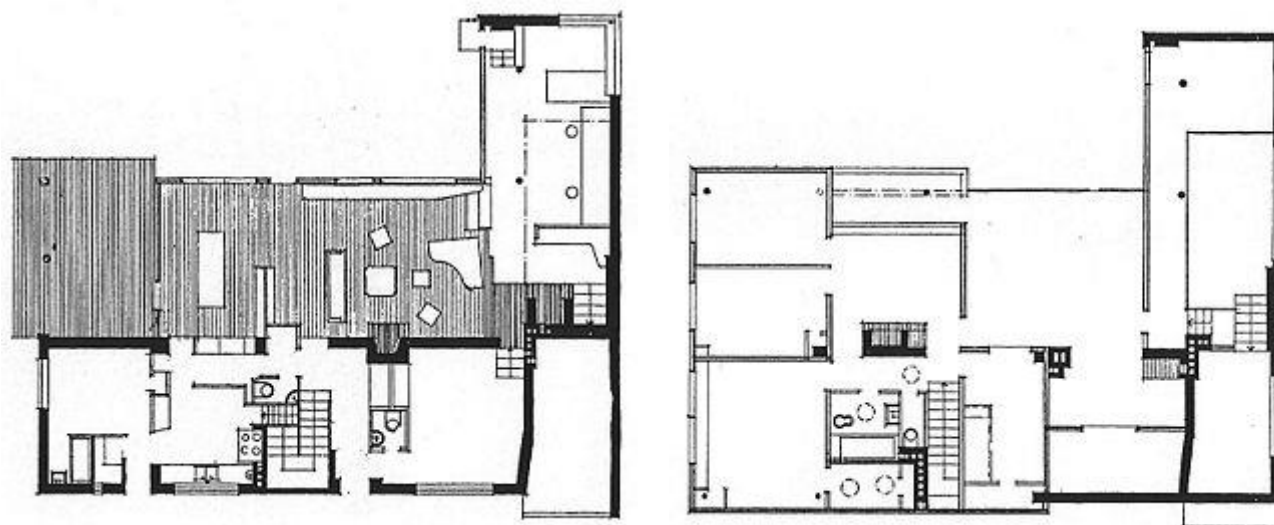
Plantas da Habitação e seu Estúdio
